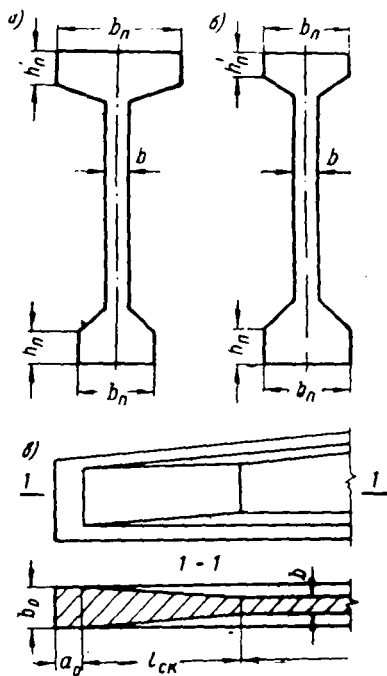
Основные типы и размеры сечений двутавровых балок
